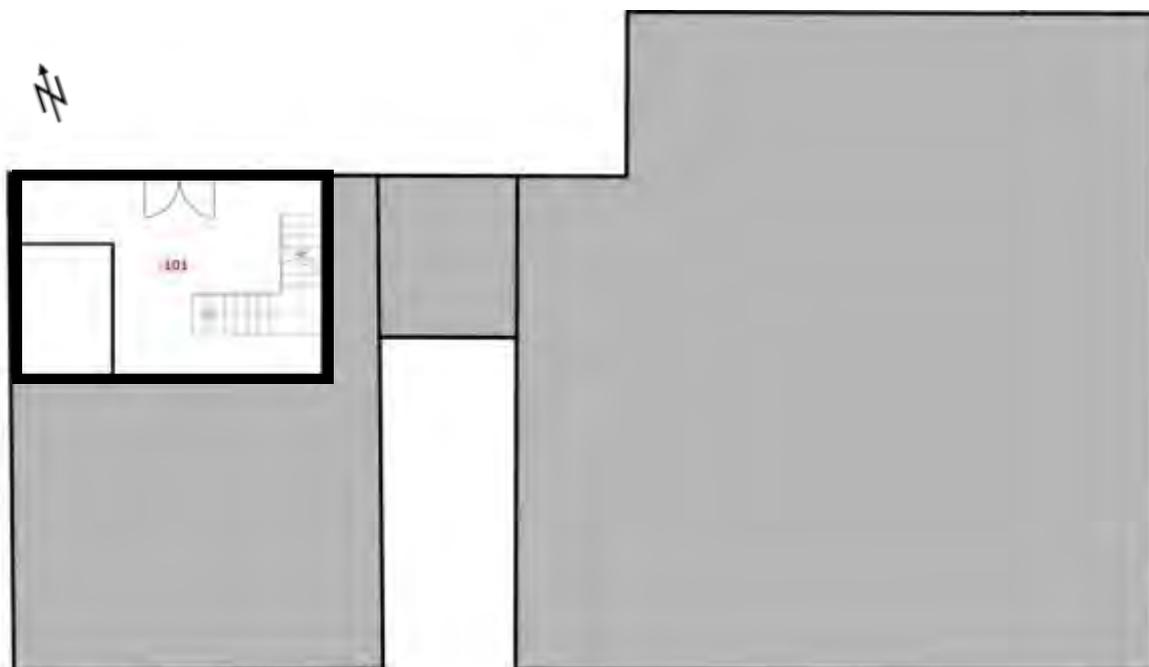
Schematischer Grundriss Keller. Bearbeitung IBID.
